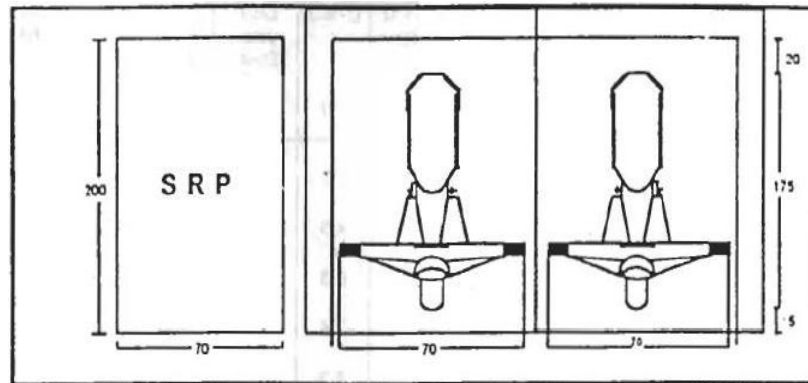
1 Satuan Ruang Parkir Mobil Penumpang
